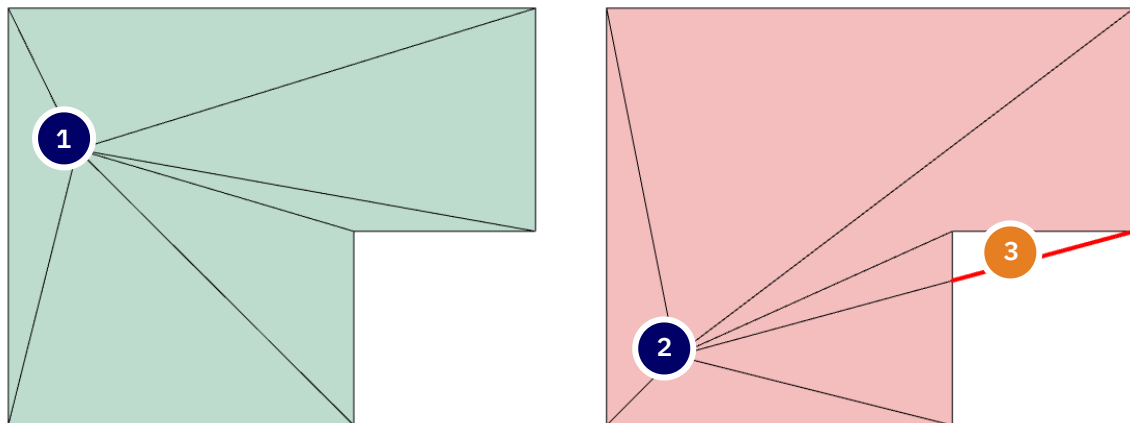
· L-förmiger Grundriss mit gleichmäßigen Wandanschlusshöhen. Links die tragfähige, rechts die kritische Gully-Lage.
